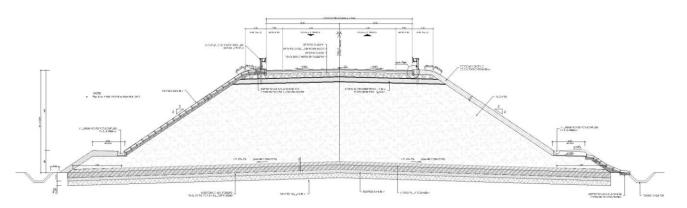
CAT. F1 sezione tipo in rilevato Hril > 6.00 m
